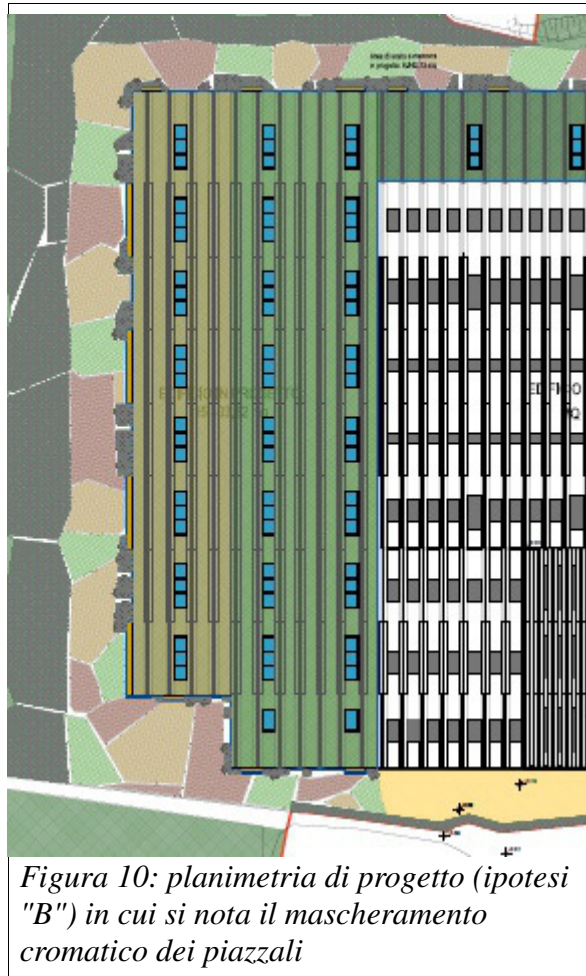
planimetria di progetto (ipotesi "B") in cui si nota il mascheramento cromatico dei piazzali
